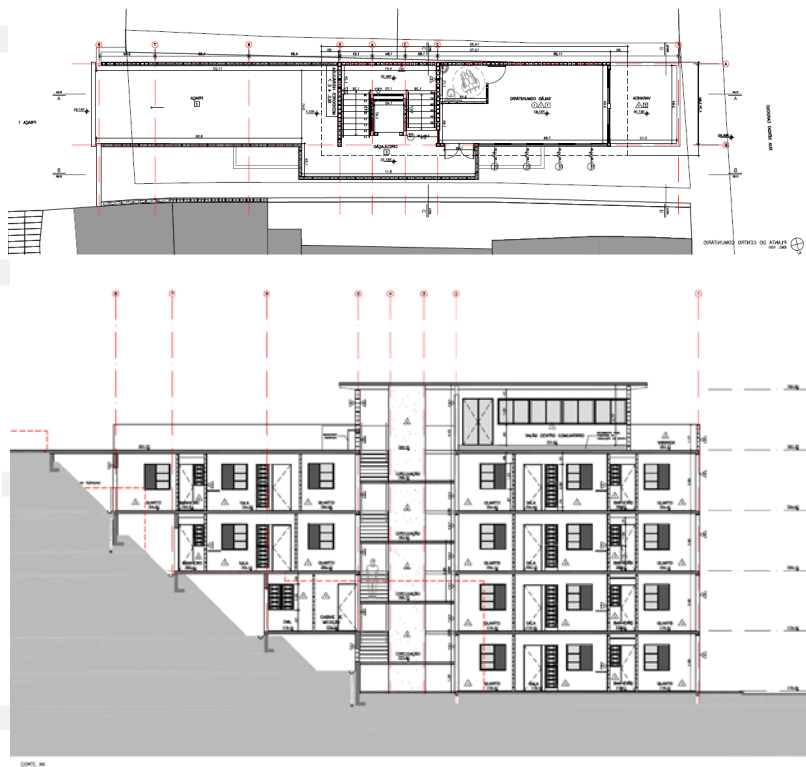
planta e corte do edifício bloco 4 revelando a circulação vertical pública e o salão
